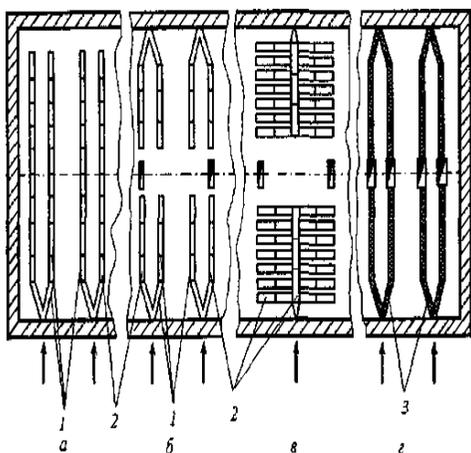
Схема стационарных установок для вентиляции зерна в складах с горизонтальными полами: а - СВУ-1; б - СВУ-2; в - СВУ-3; г - аэрожелоба: 1 - деревянные щиты; 2 - щели для выхода воздуха; 3 - перфорированное перекрытие вентиляционных каналов
